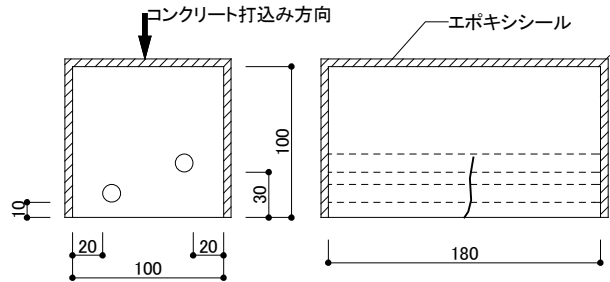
非貫通ひび割れ試験体(試験体タイプB)
